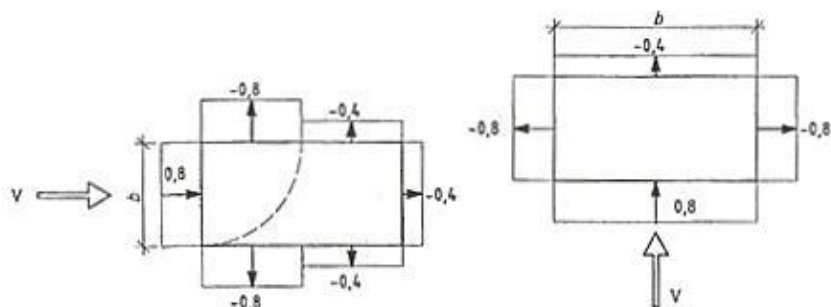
Door de wind veroorzaakte krachten op (onderdelen van) bouwwerken
